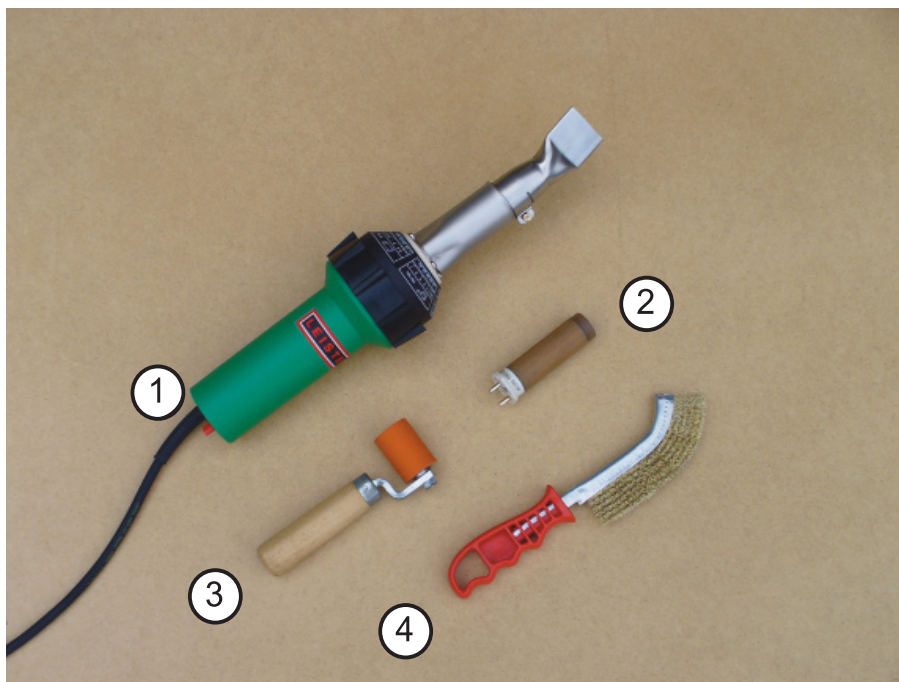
1) Ручной сварочный аппарат Leister Triac;
